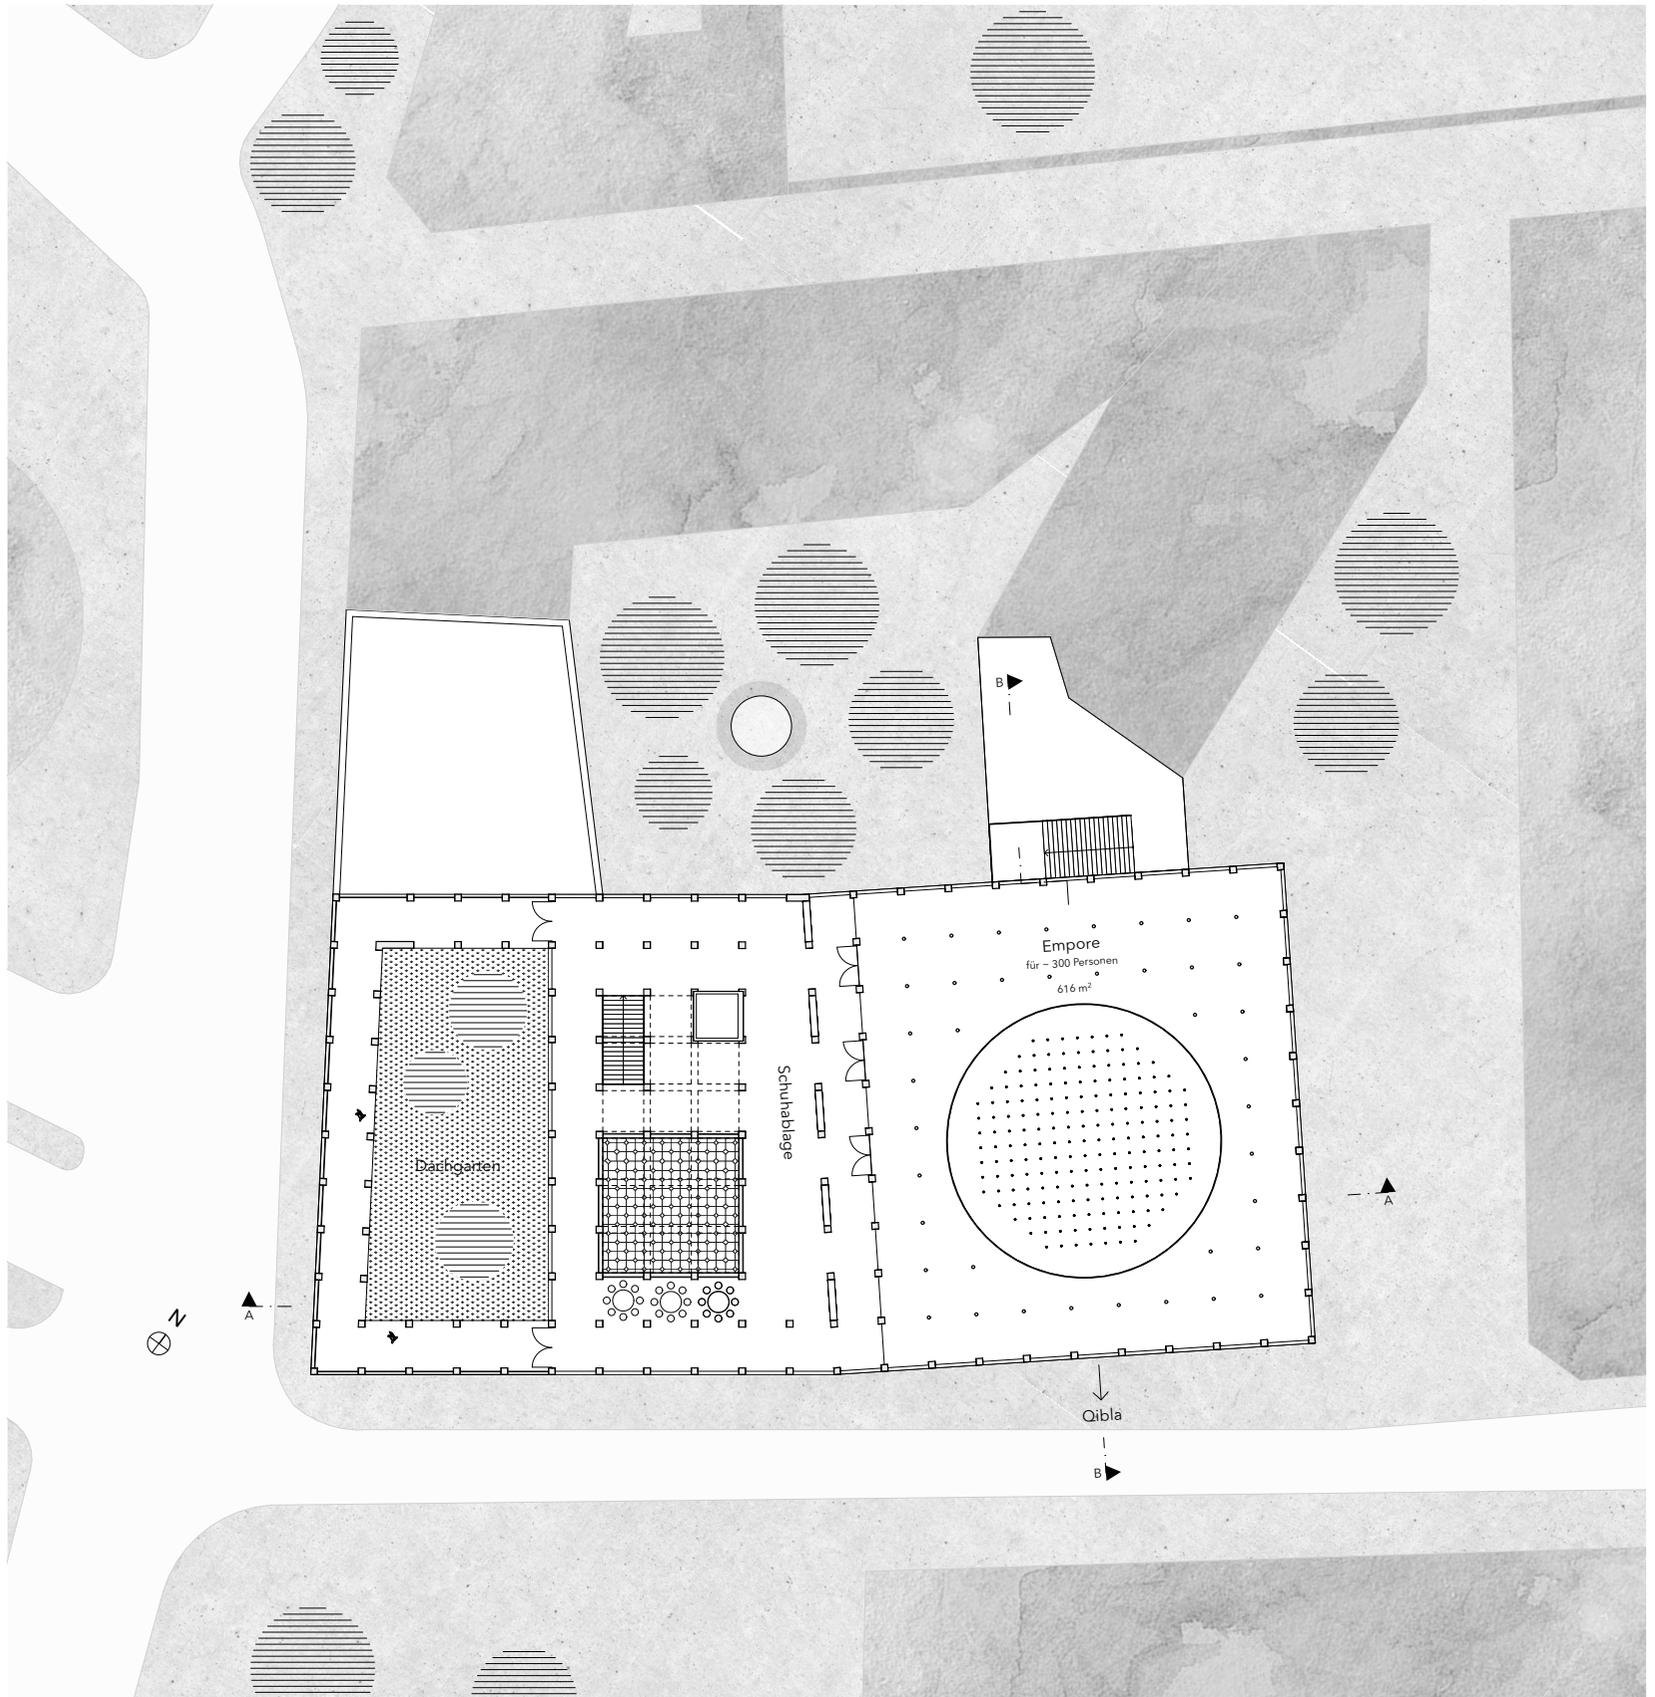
Grundriss Ebene 5 | 1:500
